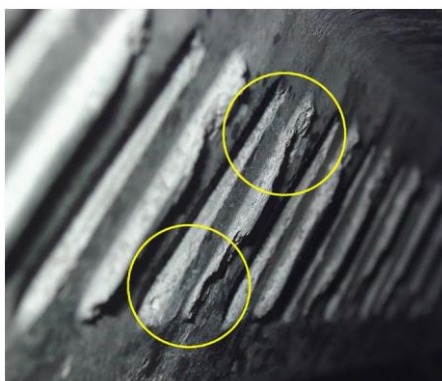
Rotura por corte longitudinal - interface após ensaio de flexão (adaptado [17])
